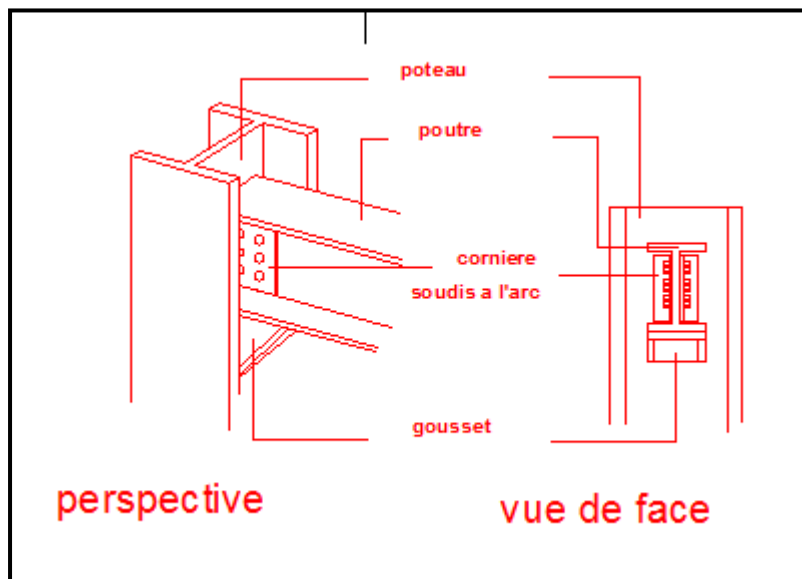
Schéma d'un détail d'attache d'u poteau et poutre métallique Source : Auteurs
